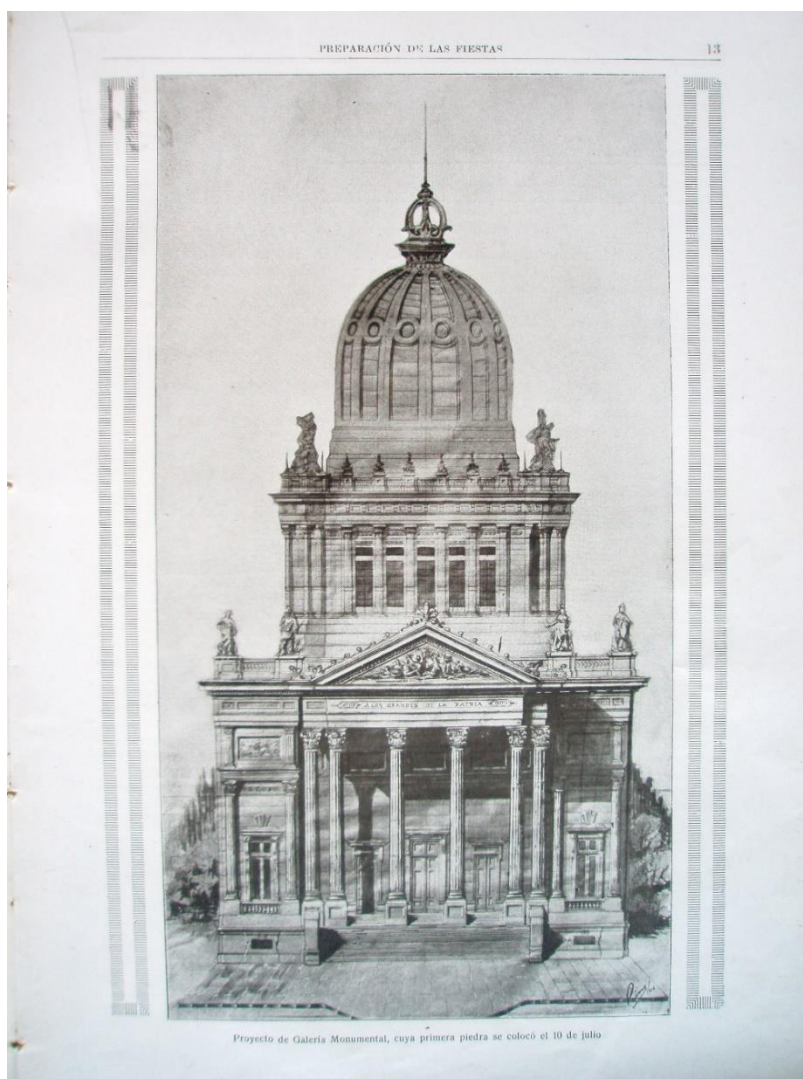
Fachada de la Galería de la Independencia, Álbum del centenario. ACHIT
